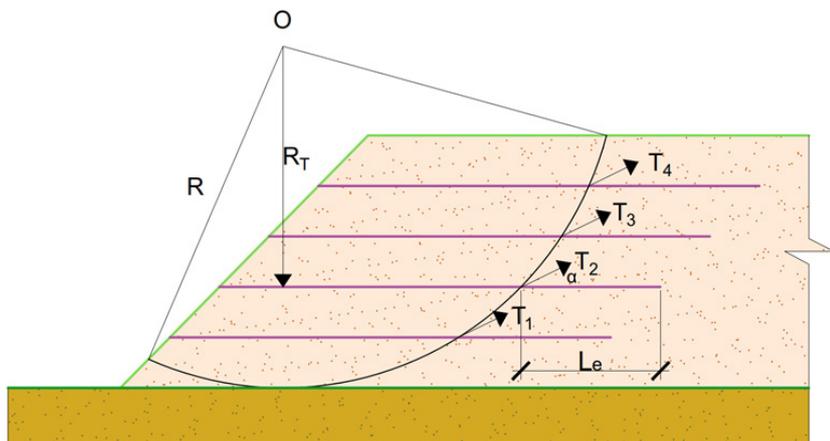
Расчетная схема для определения общей устойчивости армированного откоса
